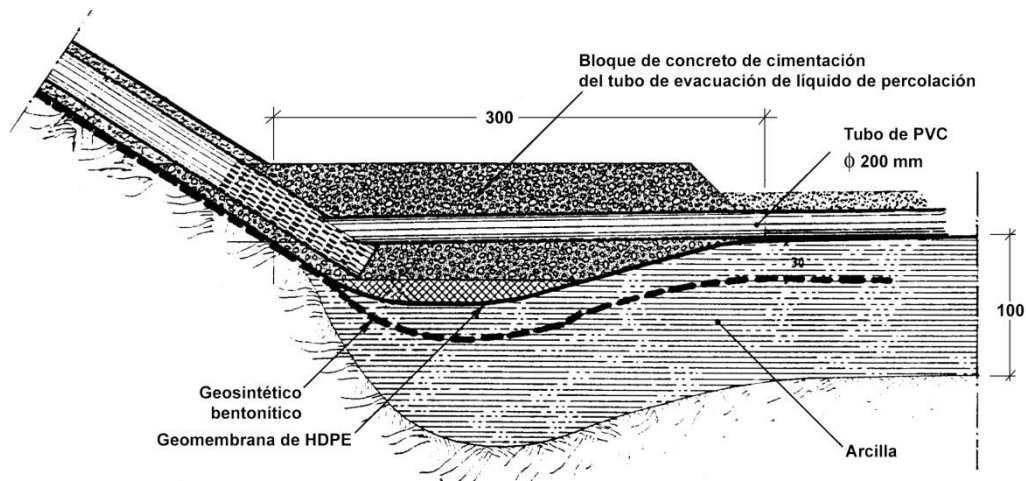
Impermeabilización del fondo y de la pared de un vertedero. Encima del sistema de aislamiento se encuentra el sistema de drenaje y evacuación del líquido de percolación
